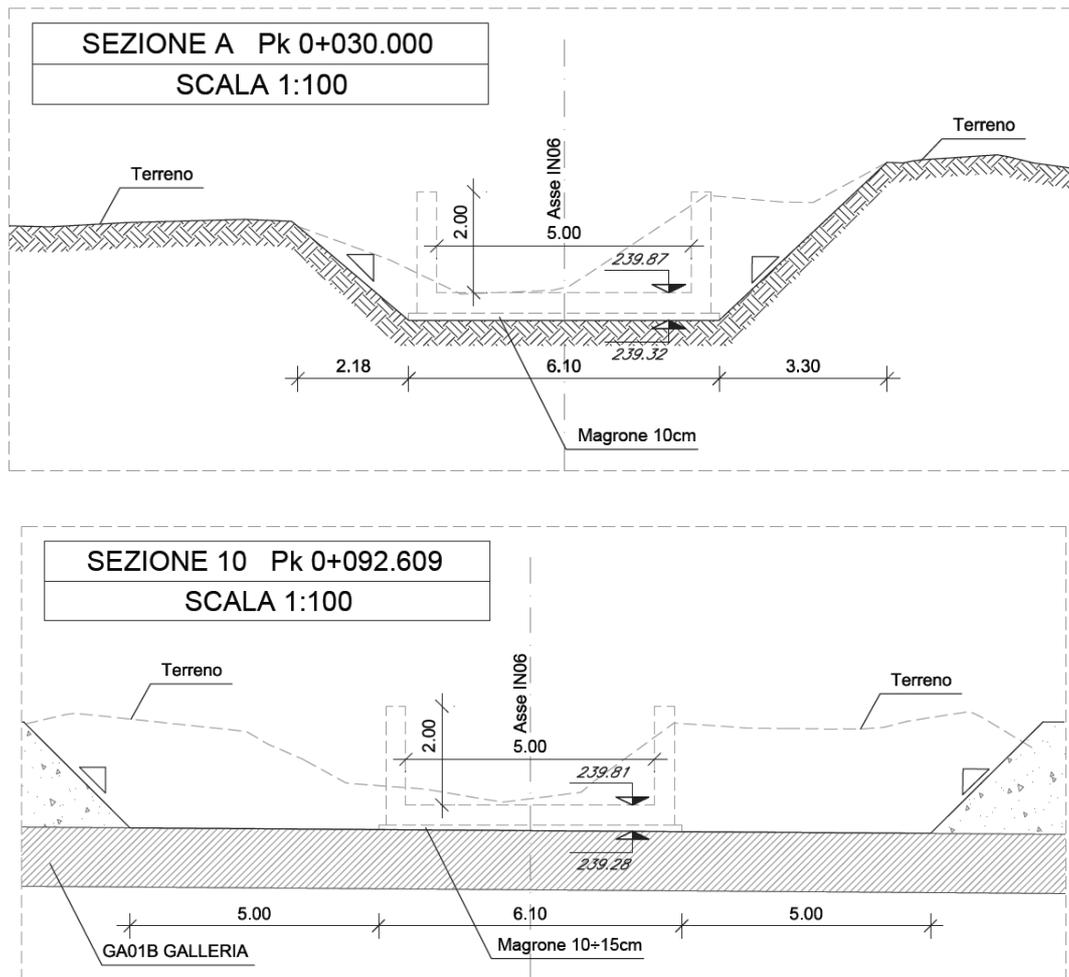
Sezione A e sezione 10 dell’opera IN06
